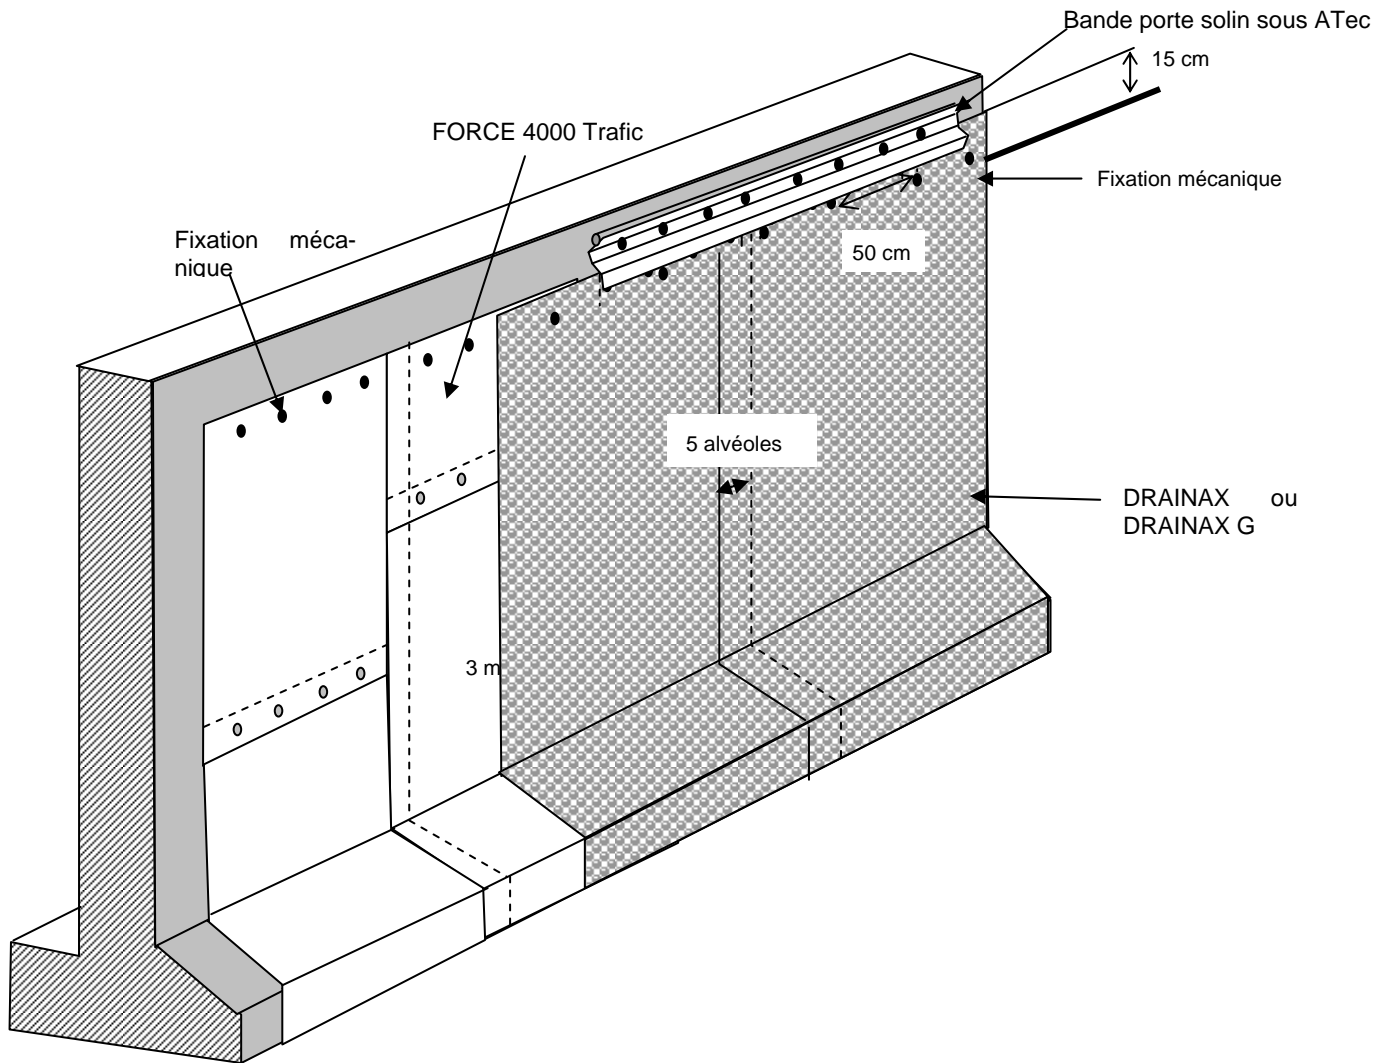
bis – Exemple de mise en œuvre du DRAINAX / DRAINAX G sur revêtement d'étanchéité pour $h > 2\text{ m}$
